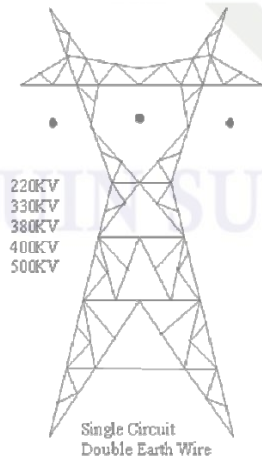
Tiang / Tower Tipe Pole[28][29]
